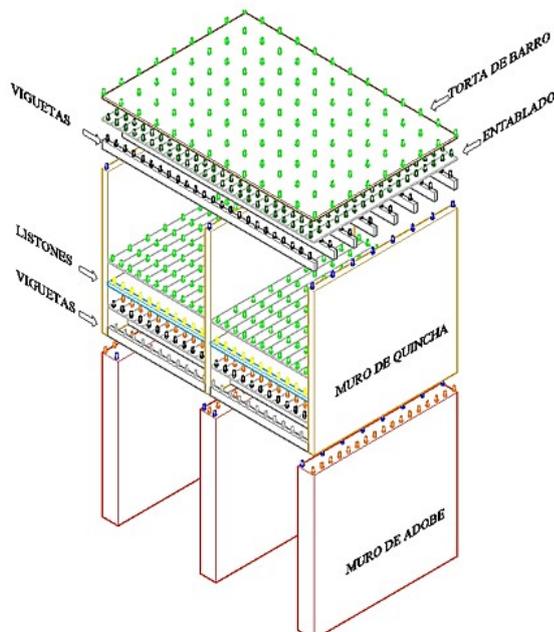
Componentes estructurales del sistema Adobe - Quincha
